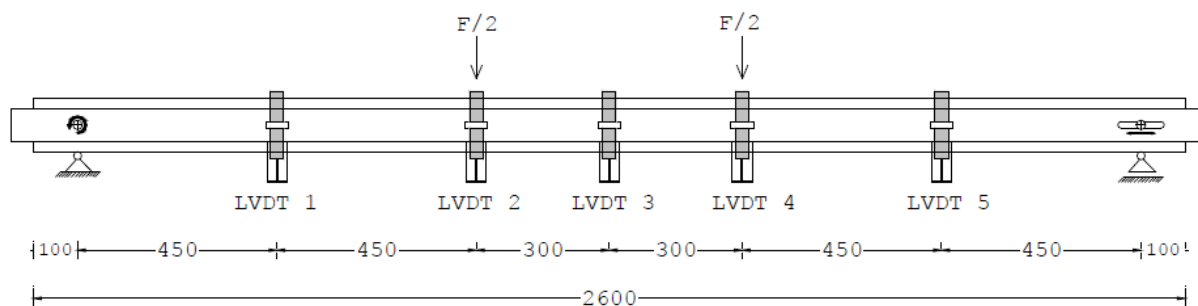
Posição dos LVDT's nas lajes ensaiadas (dimensões em mm).
